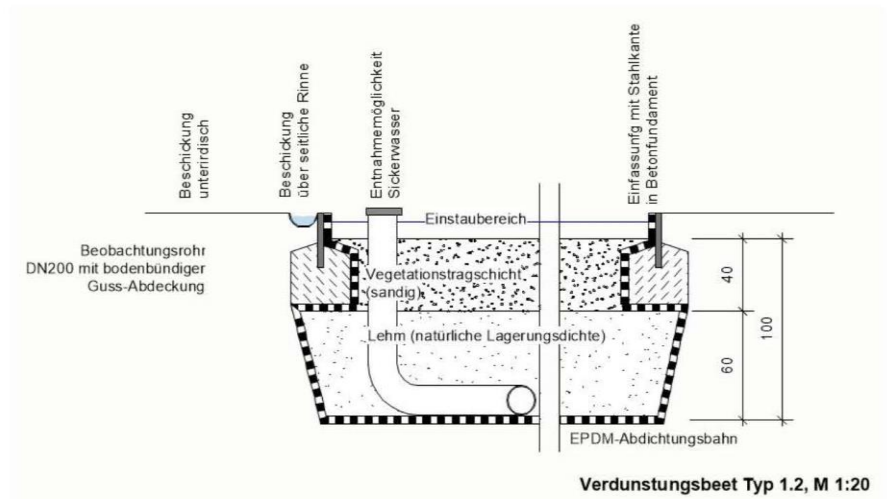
Detail Verdunstungsbeet Typ 1.2
